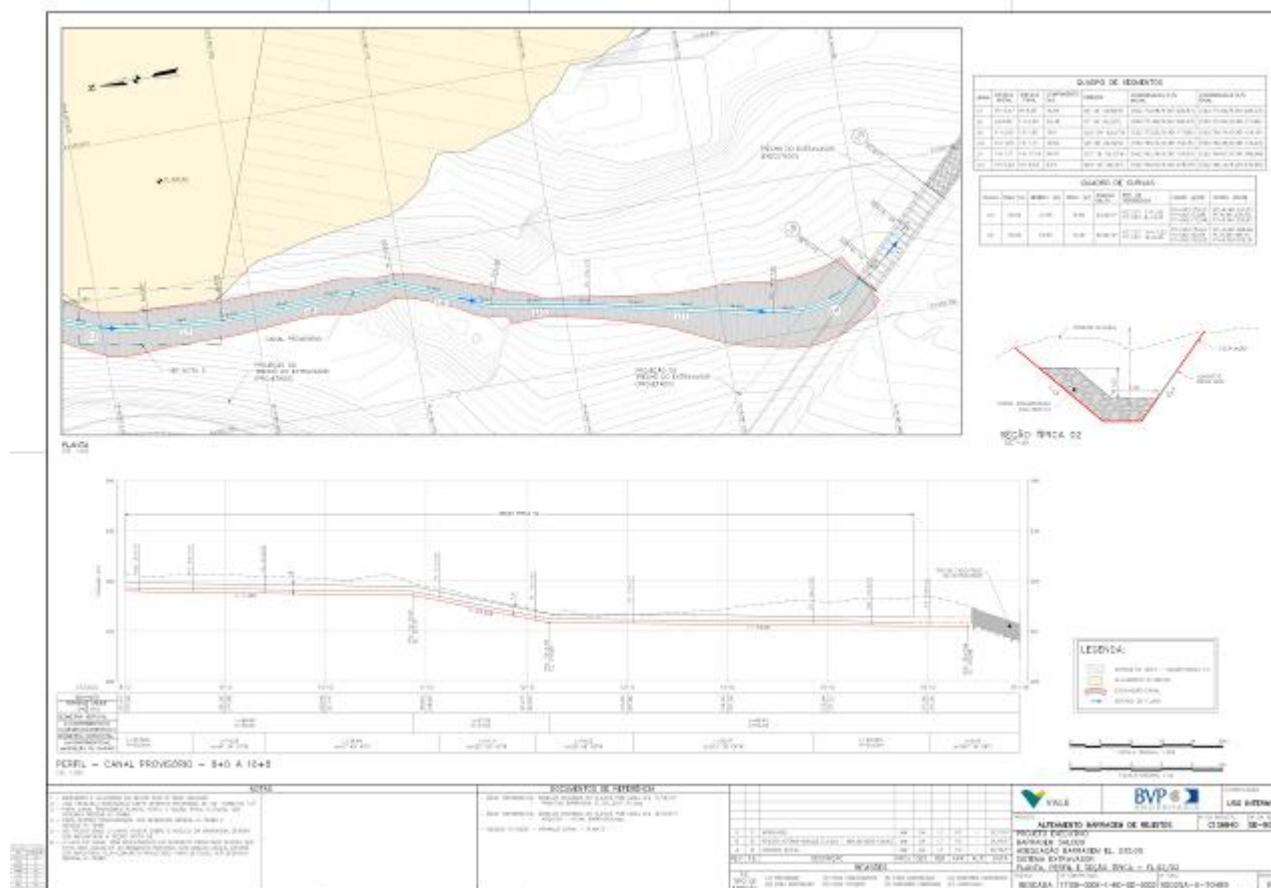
Planta e perfil longitudinal do extravasor da elevação 225,0 m. Reprodução do documento 9002SA-X-70489.
